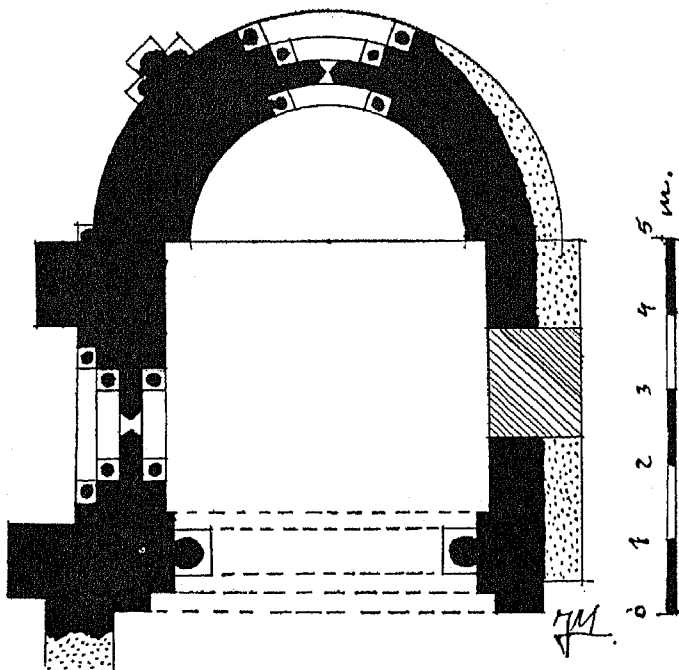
Planta de la capilla del cementerio de Treviana.
